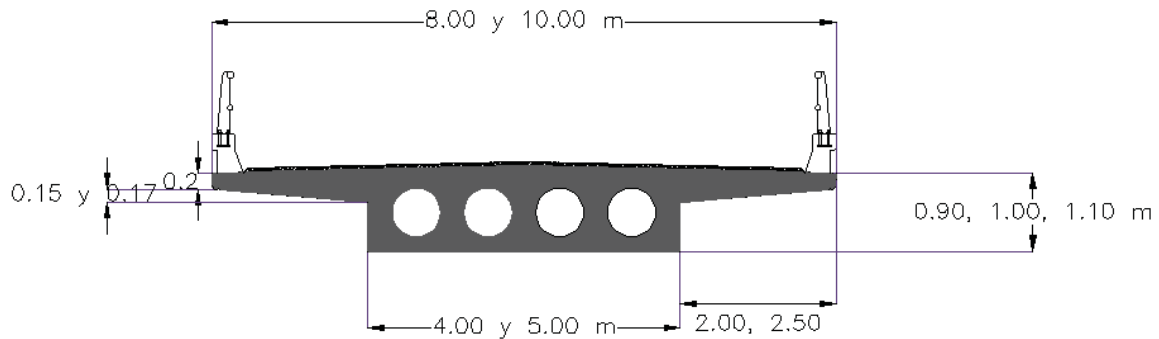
Sección transversal tipo de puente con losa aligerada
